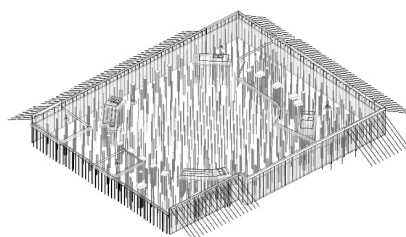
Losa de encepados sobre pilotes y muros de pantalla.
